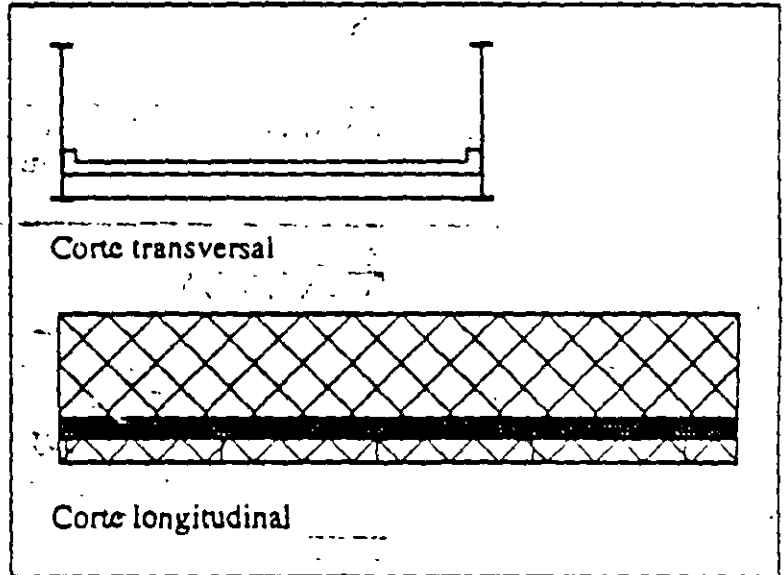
Sección transversal, tipo 44, Trabe de Celosía
